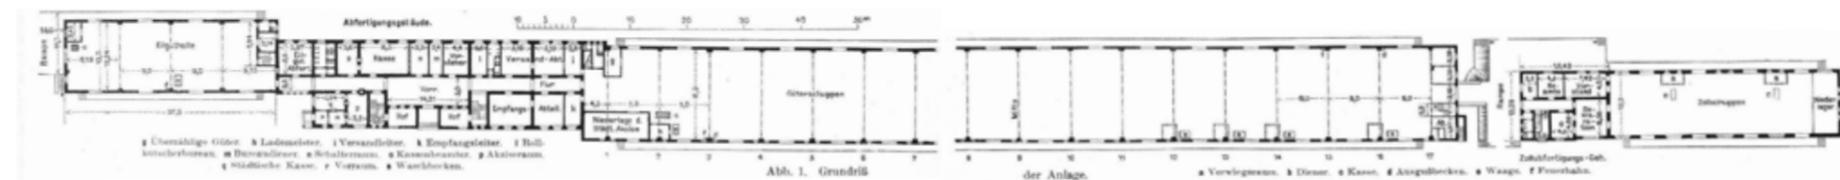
Plan mit Grundriss des Erdgeschosses der Gesamtanlage, 1907
